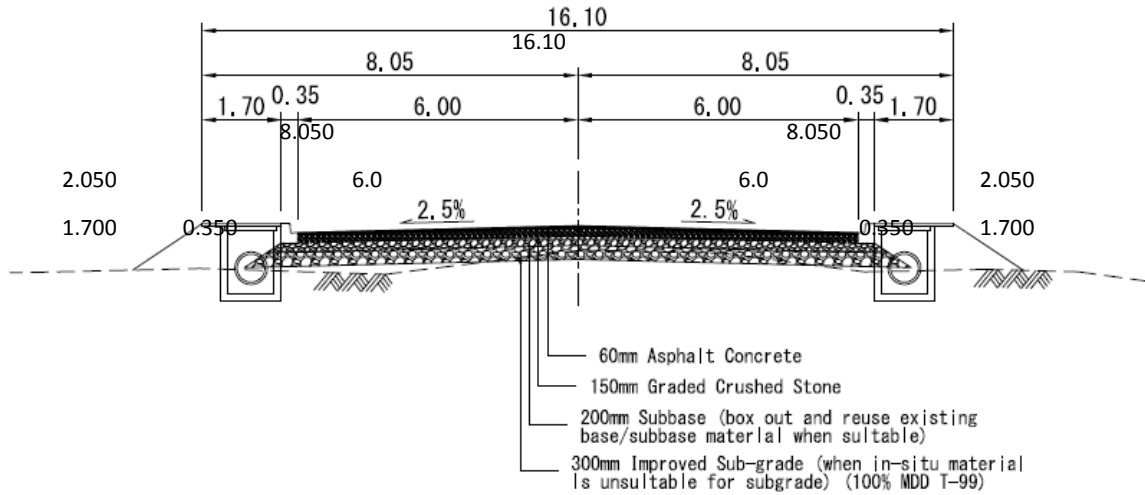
道路標準断面 (計画) Road C2 (橋梁 No.1)
